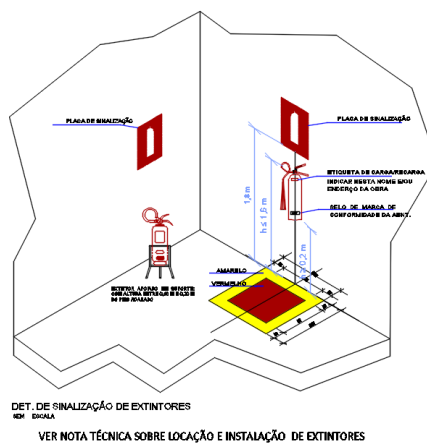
Detalhe de Instalação dos Extintores e suas Placas de Sinalização
